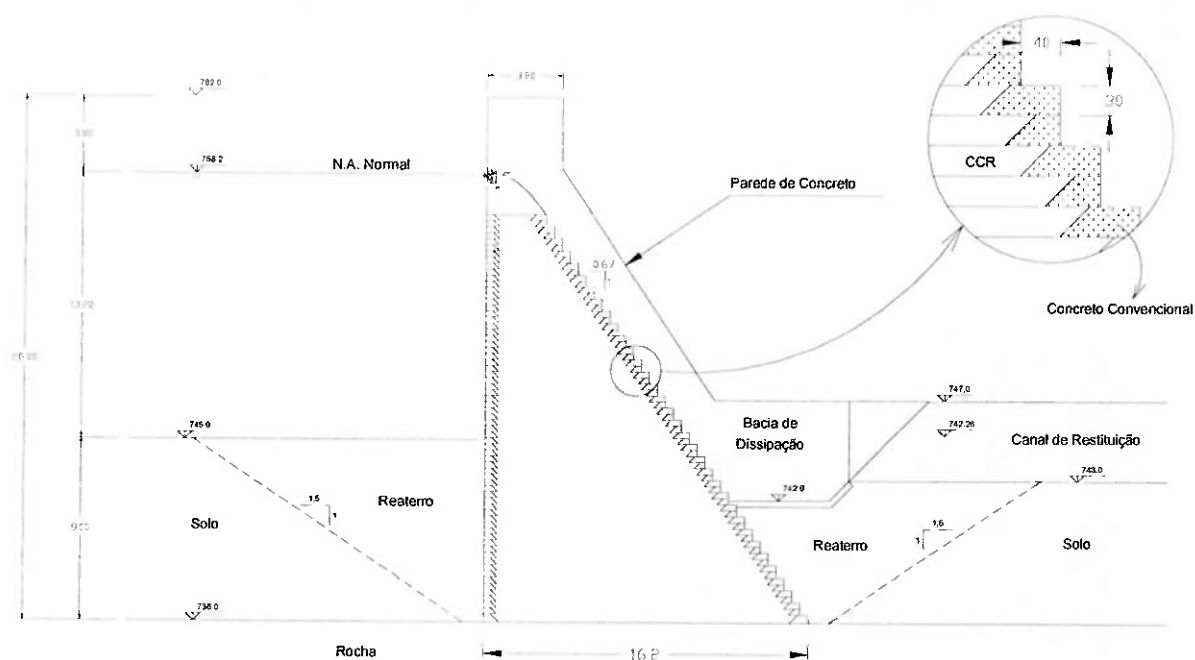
Estrutura da Barragem – Seção transversal do vertedor
